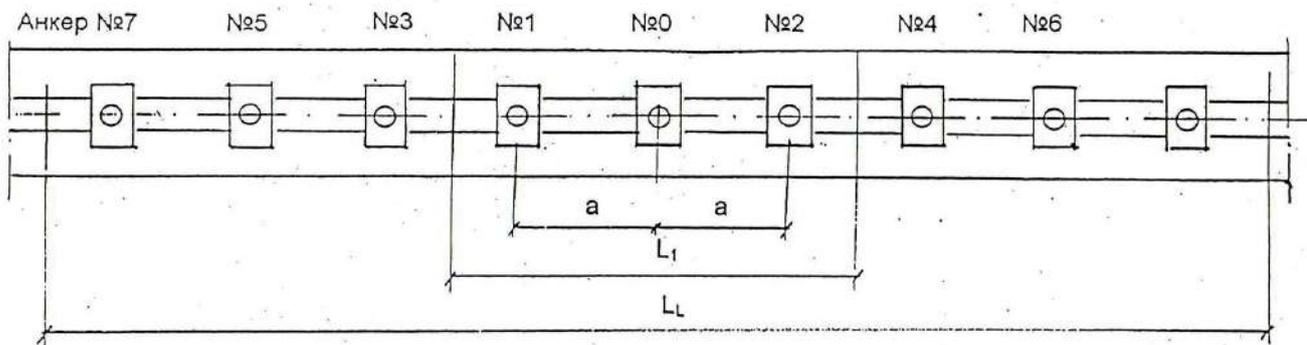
Схема расположения анкеров на продольном поясе (анкер № 0 – отказ при испытании)
